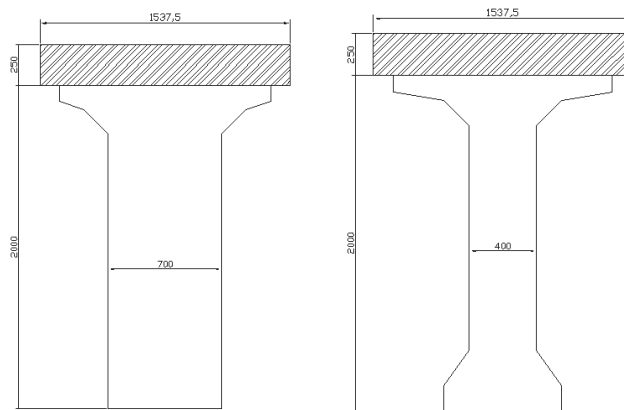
Section poutre avec hourdi intermédiaire (zone d'about et zone médiane)
